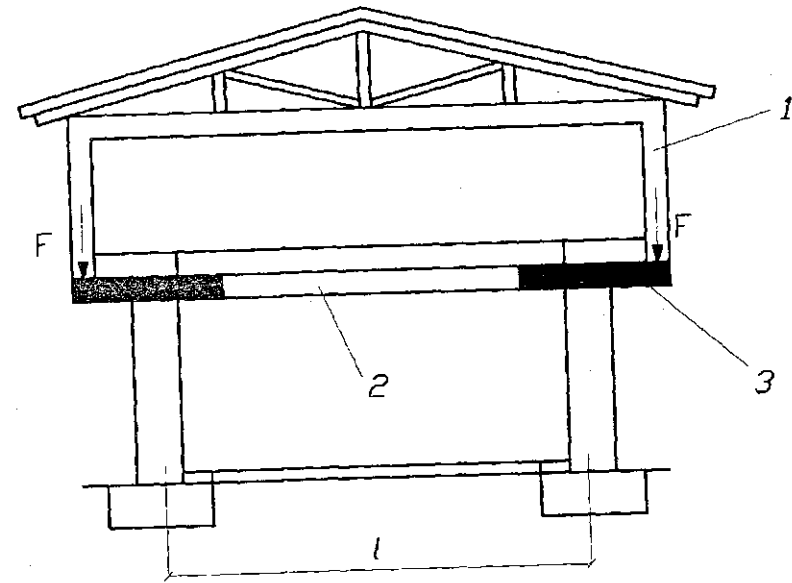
Надстройка 2-го этажа с опорой новых стен на консоли балок перекрытия: 1 — стена; 2 — балка; 3 — консоль
